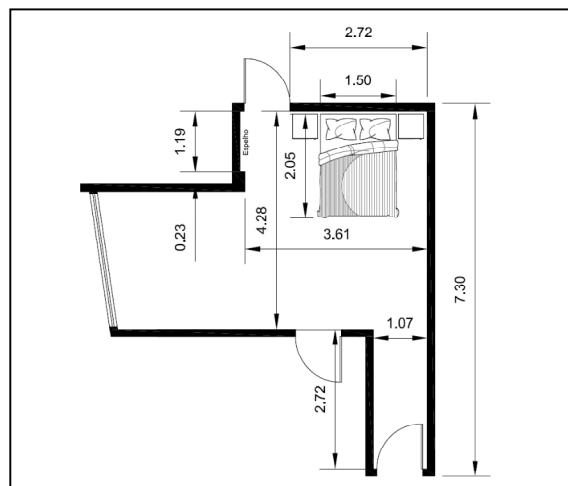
Planta baixa do quarto de Fernanda – 2ª versão
